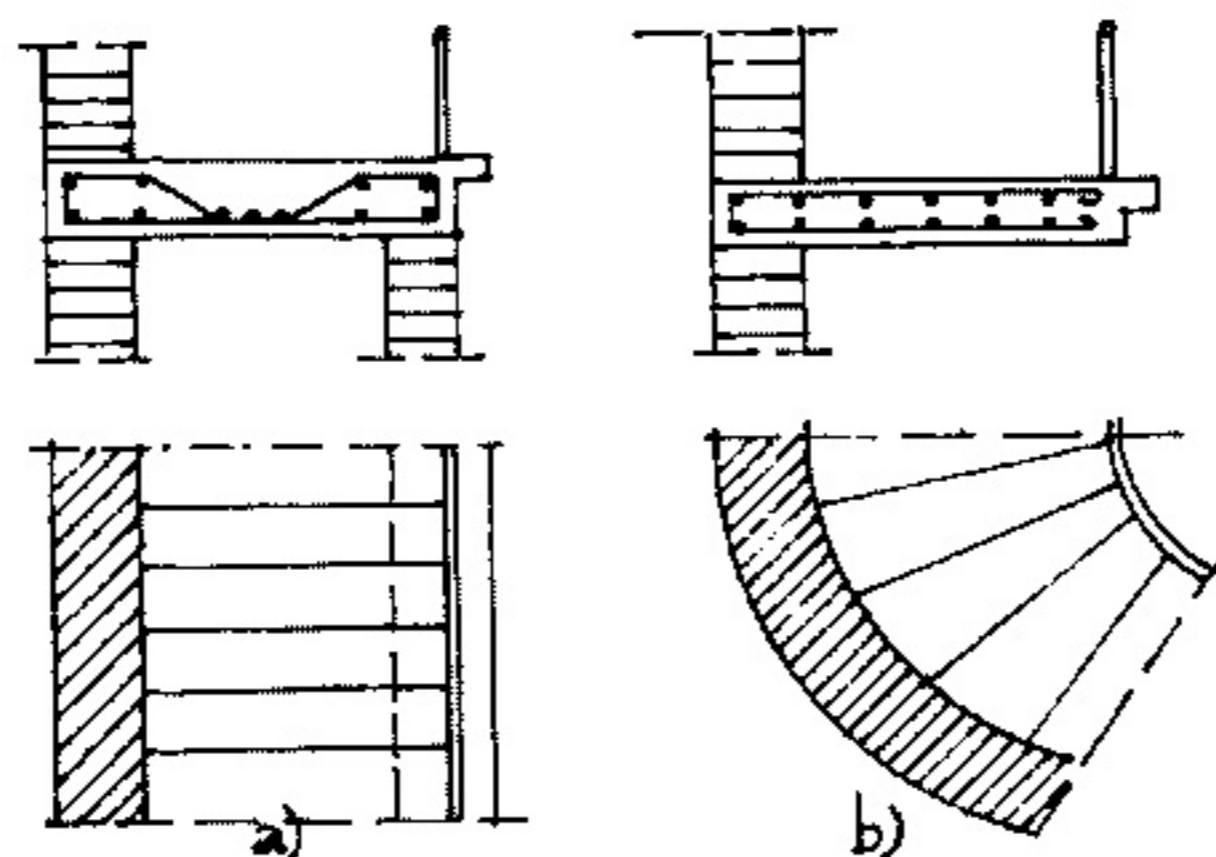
Scări din beton armat monolit: a - cu placă rezemată; b - cu placă încastată
